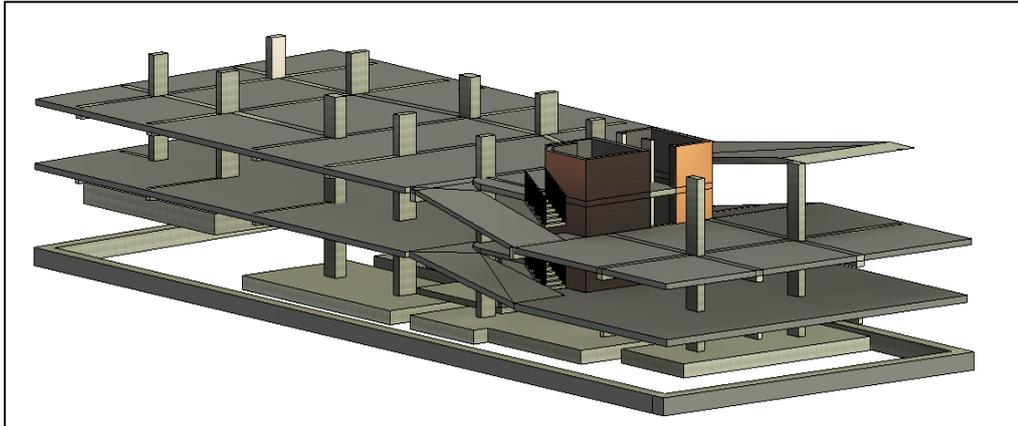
Modelamiento de columnas, vigas y losas de sótanos y primer piso.
